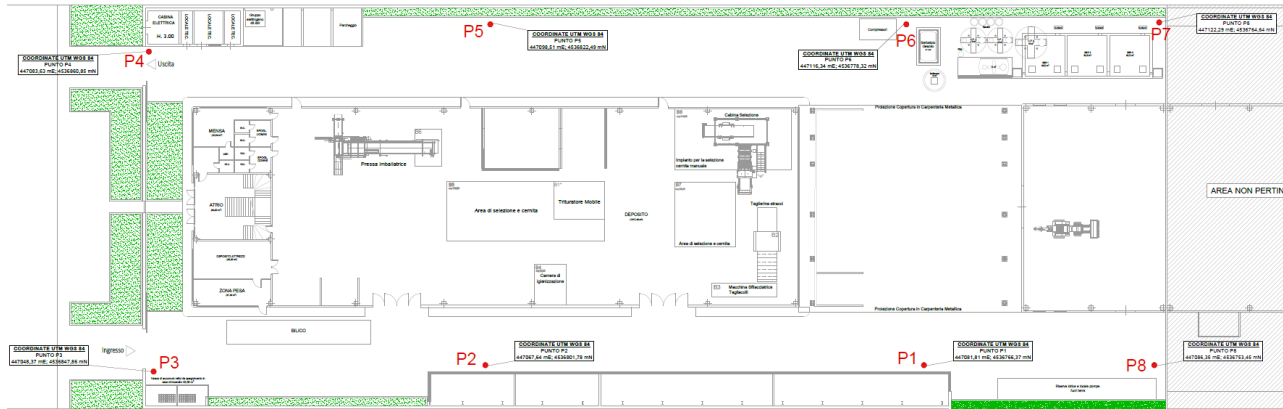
Stralcio planimetrico della Planimetria individuazione punti di misura fonometrica
